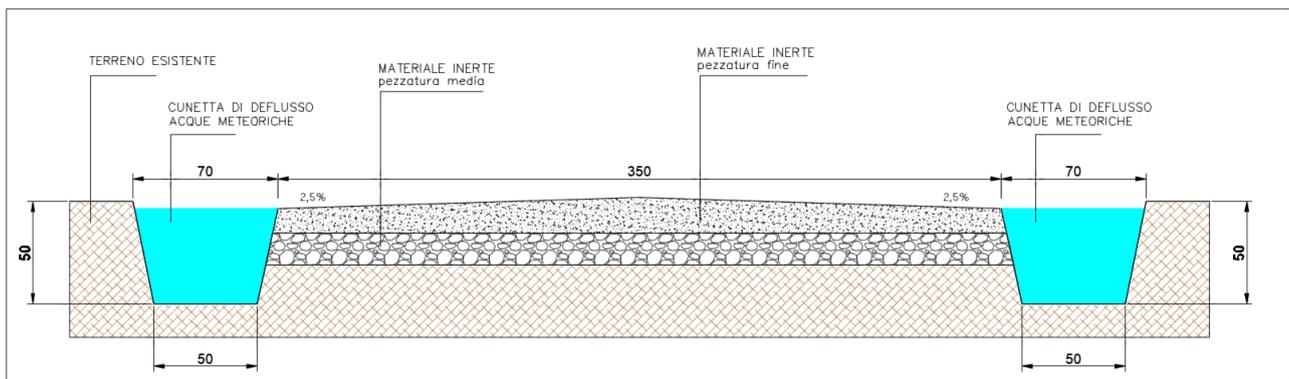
Sezione stradale e drenaggio acque meteoriche
